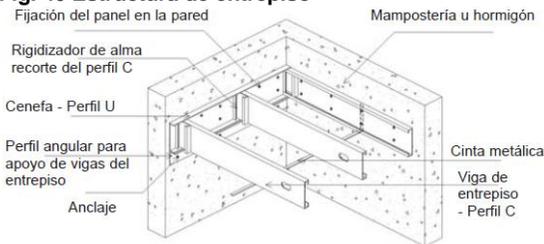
Forjado Steel Frame sobre estructura tradicional¹⁷
